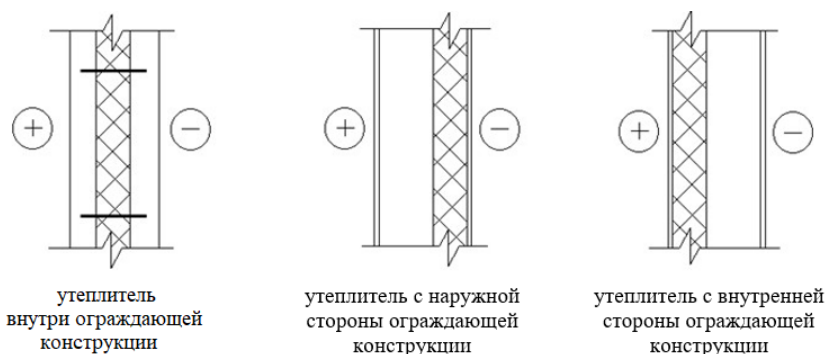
Схемы утепления наружных стен слоистой конструкции
